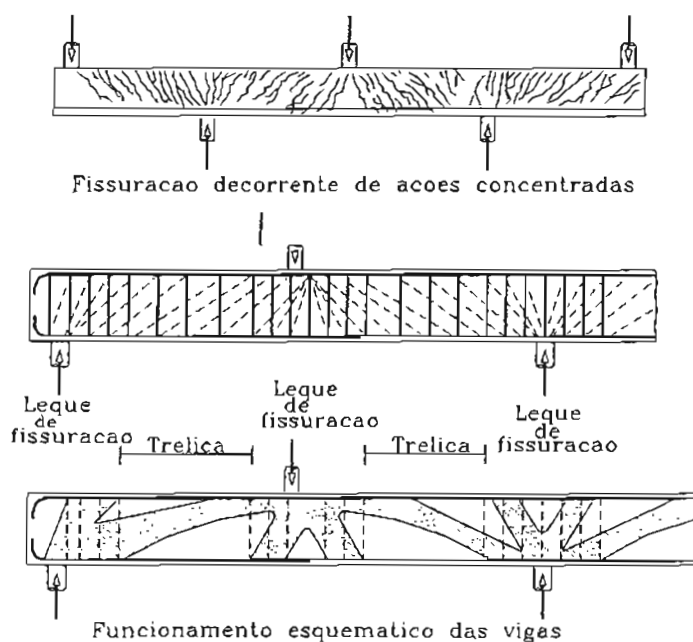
Fissuras e comportamento de treliça
